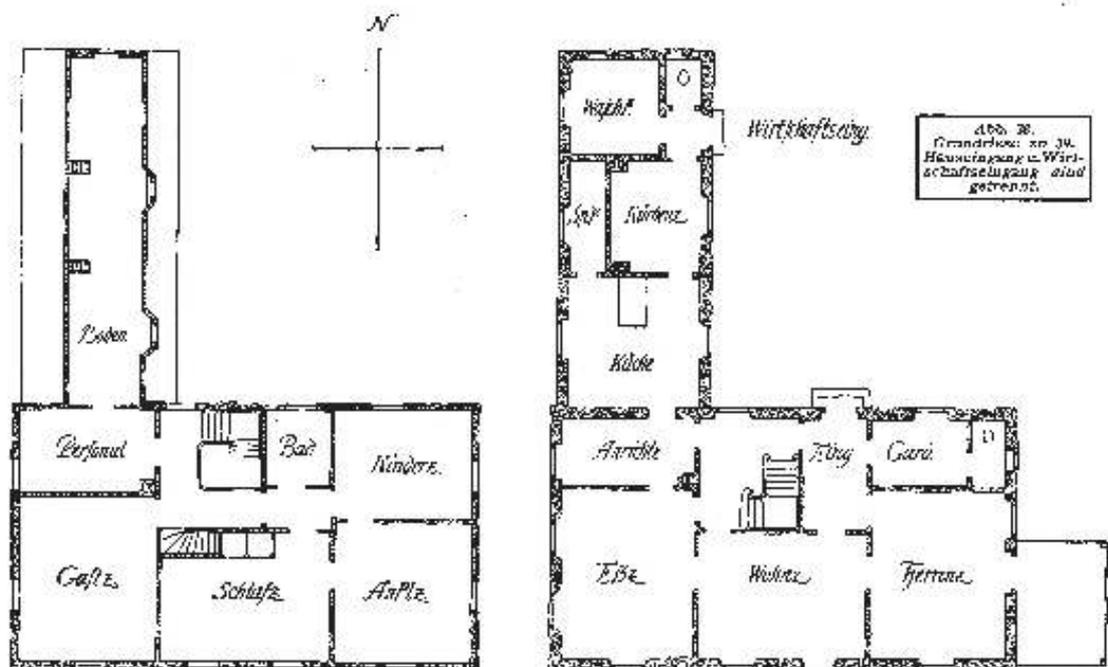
Paul Schultze-Naumburg: Ländliches Wohnhaus mit sieben Zimmern und Wirtschaftsflügel, Grundrisse Ober- und Erdgeschoss
